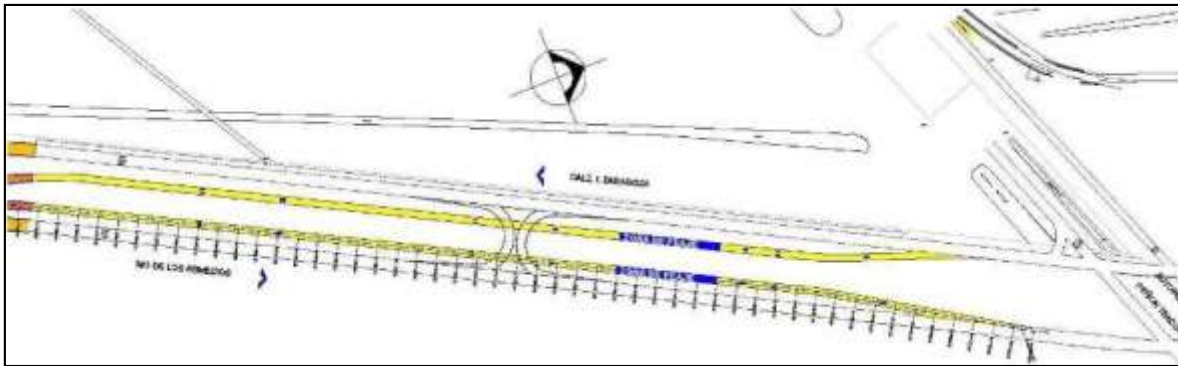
Planta de vialidad a nivel Periférico Oriente - Peñón Texcoco.
